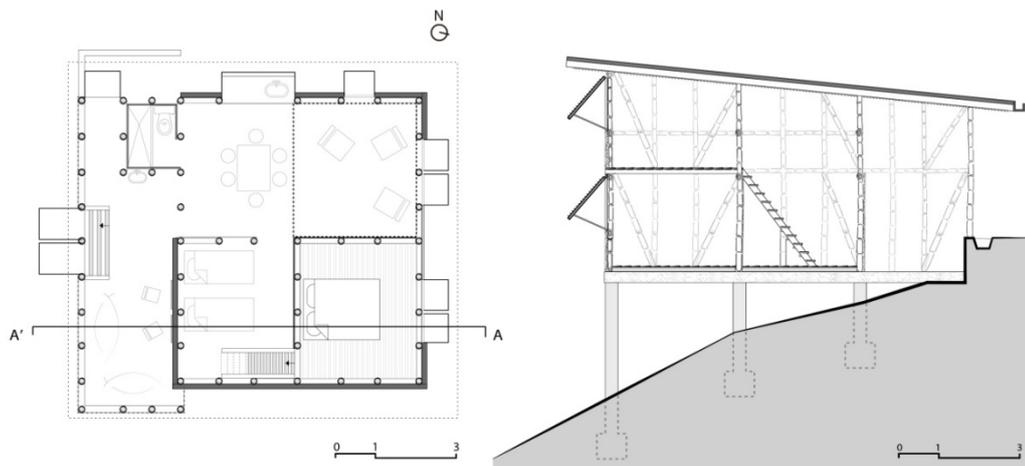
Planta y corte de la casa de Meche (elaboración Ensusitio)
